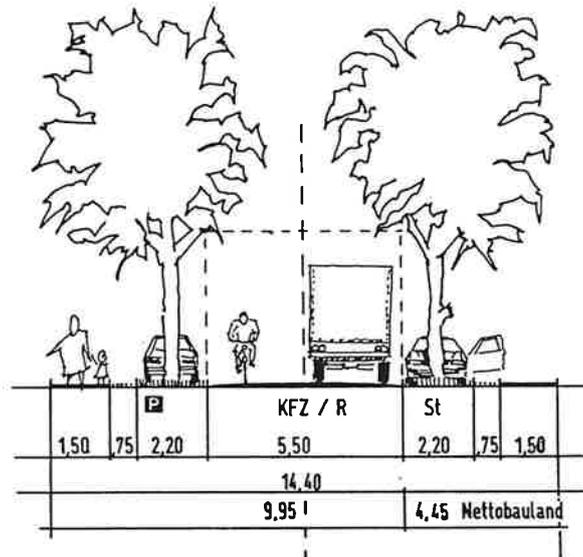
SCHNITT C₁-C₁, PLANSTRASSE D, PLANSTRASSE E
